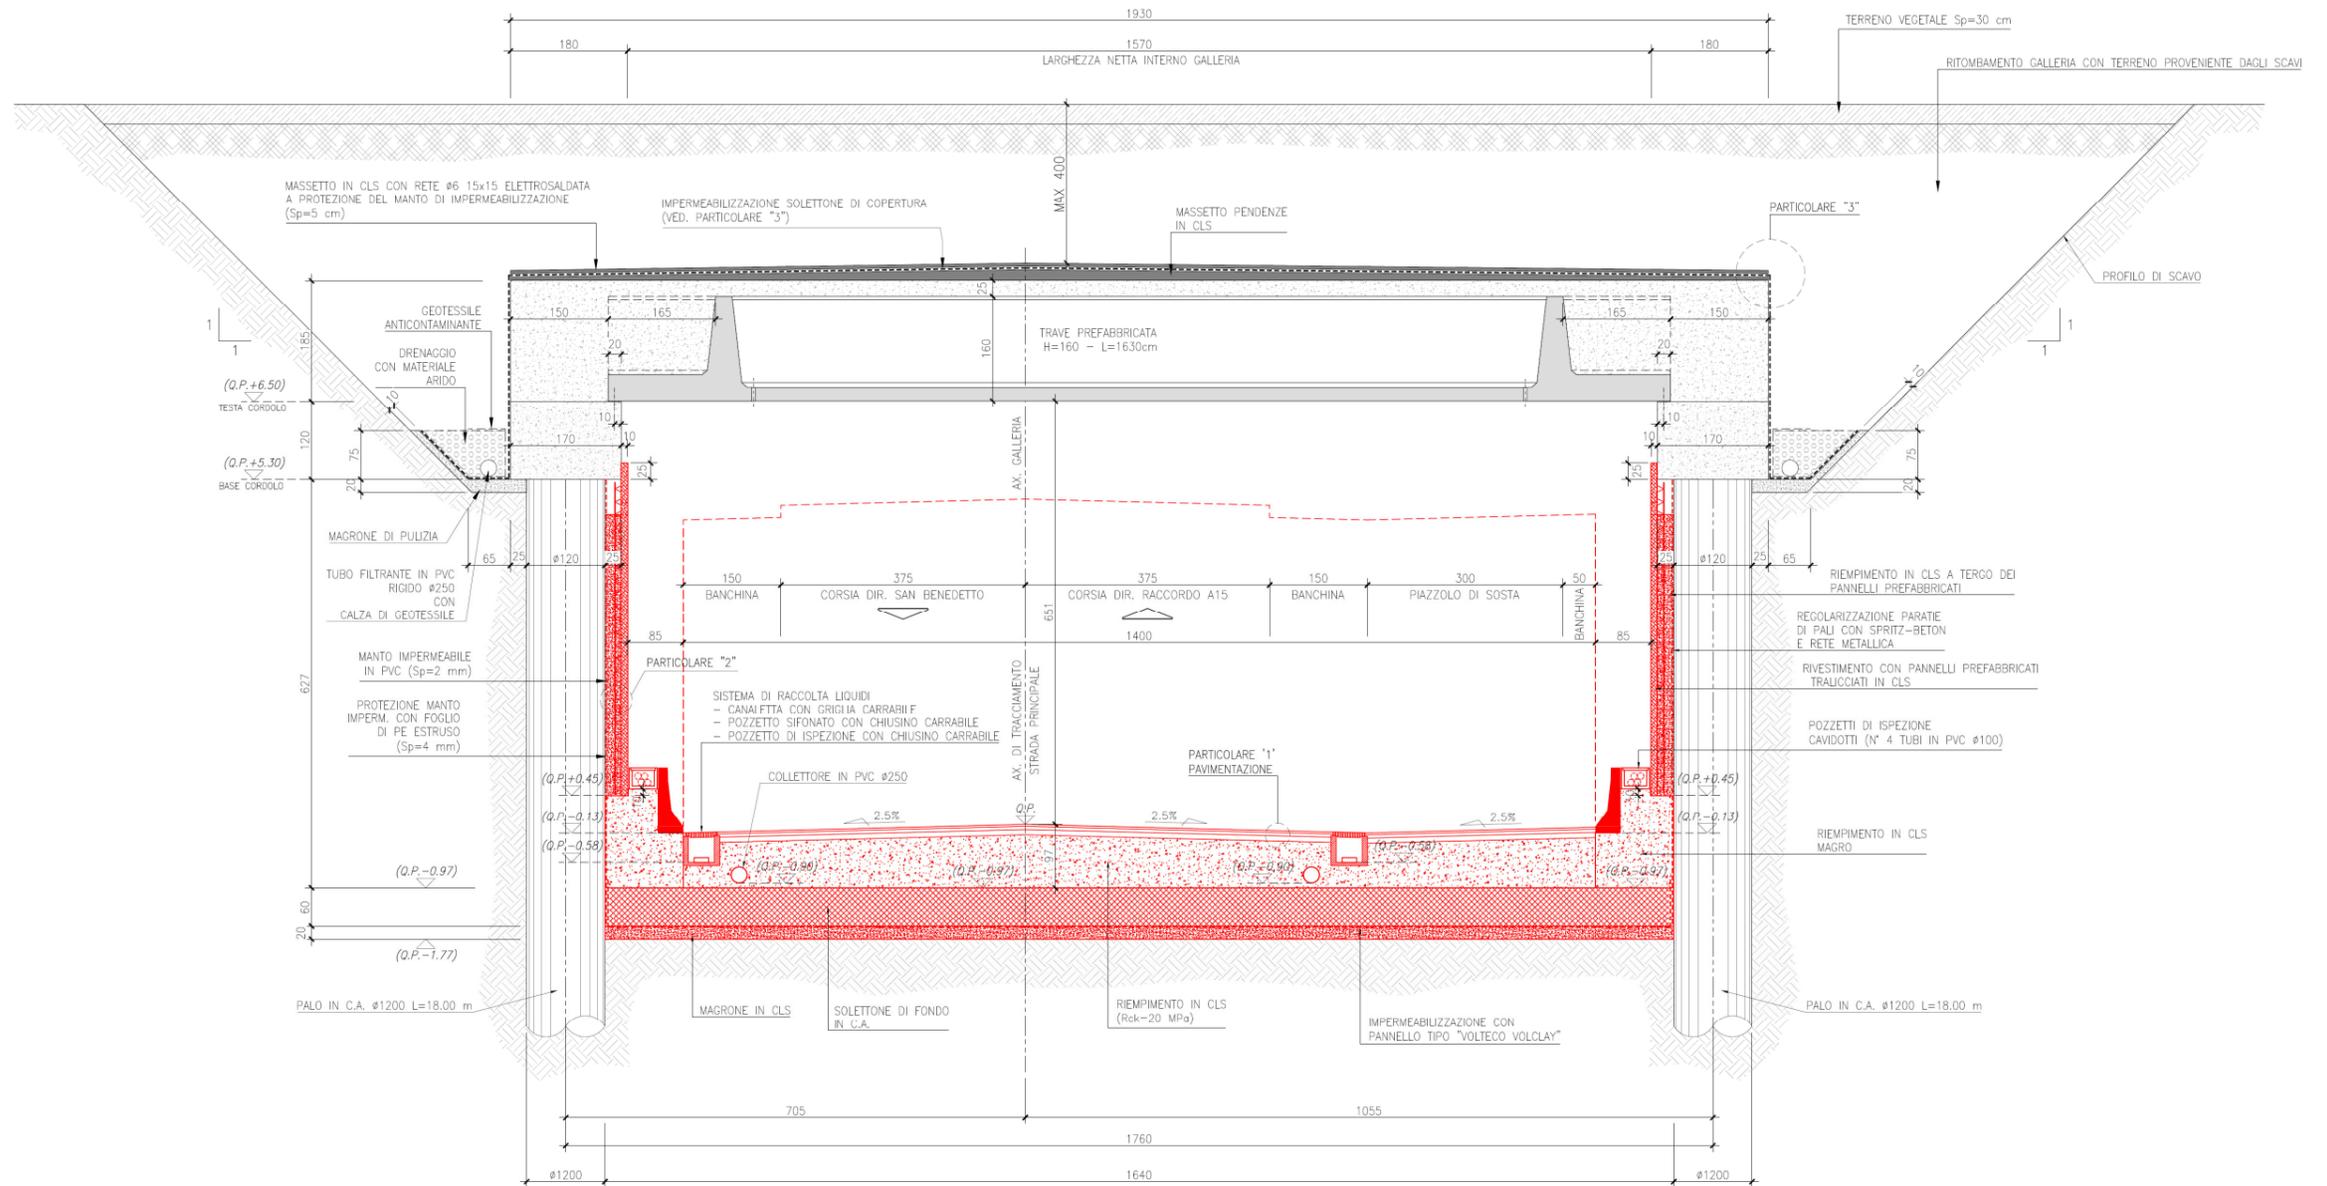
Sezione longitudinale travi prefabbricate H = 160
